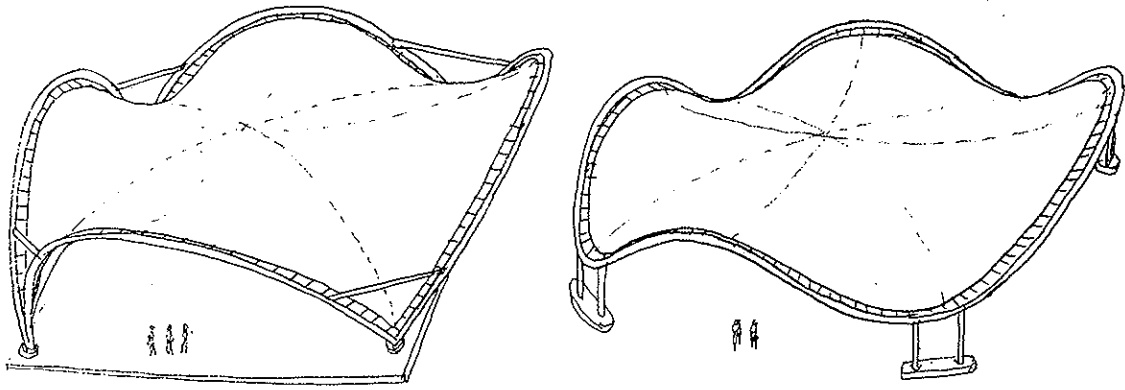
Cubiertas tensadas sobre bordes alabeados.
